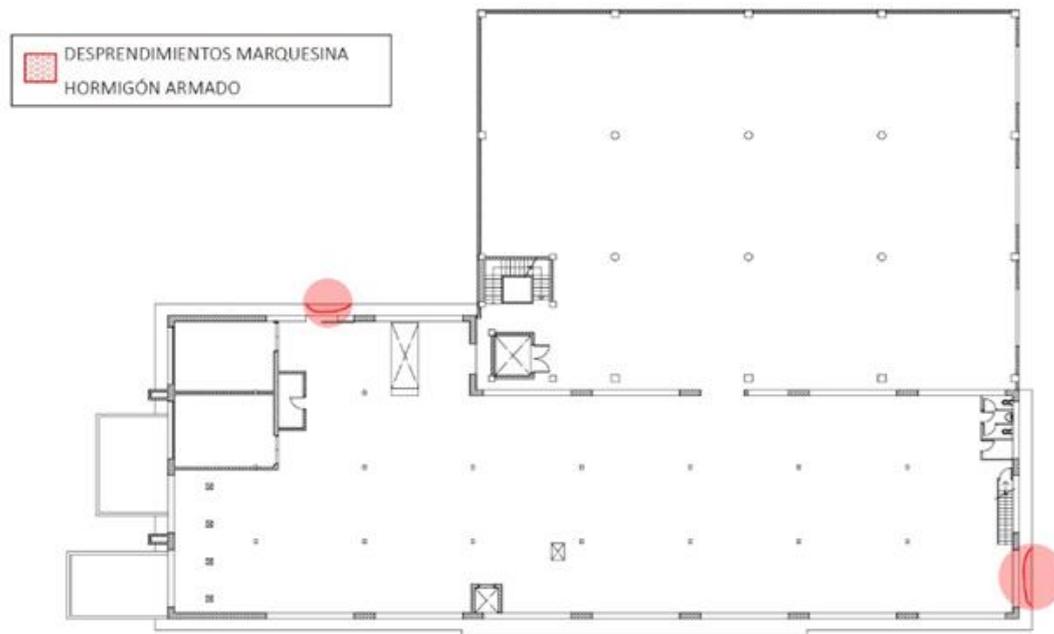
Ubicación de los desprendimientos de hormigón en la marquesina perimetral de la nave I (primera planta nave I). Fuente: elaboración propia.
